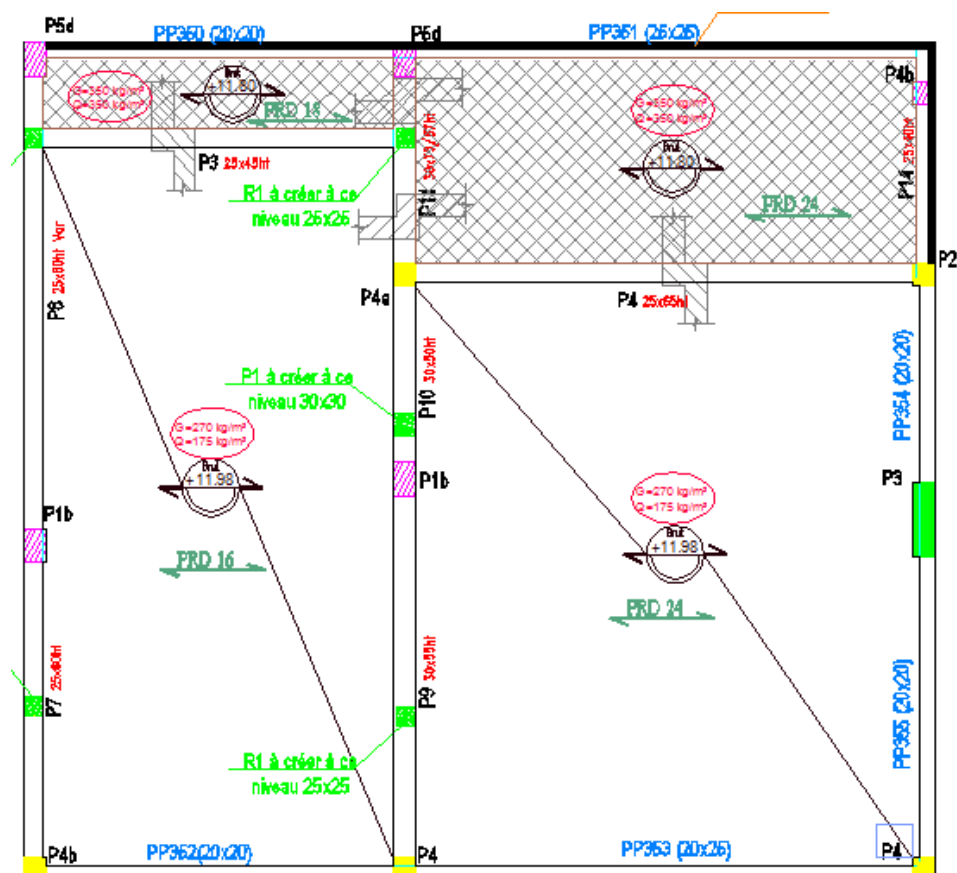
PLAN DE POSE POUTRES EN BP PREFABRIQUEES JOINT 23 PH R+2
